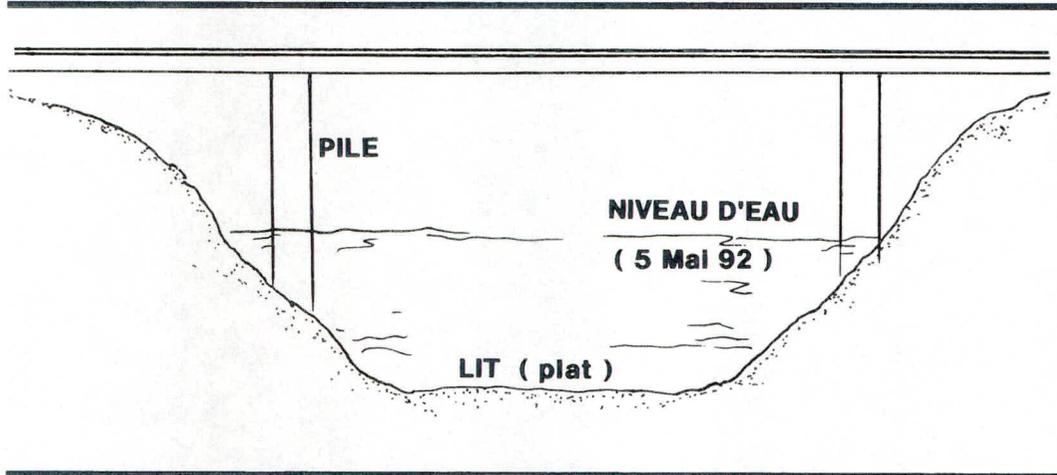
PONT ACTUEL DE L'AUTOROUTE 25 SUR LA RIVIÈRE DE L'ACHIGAN
